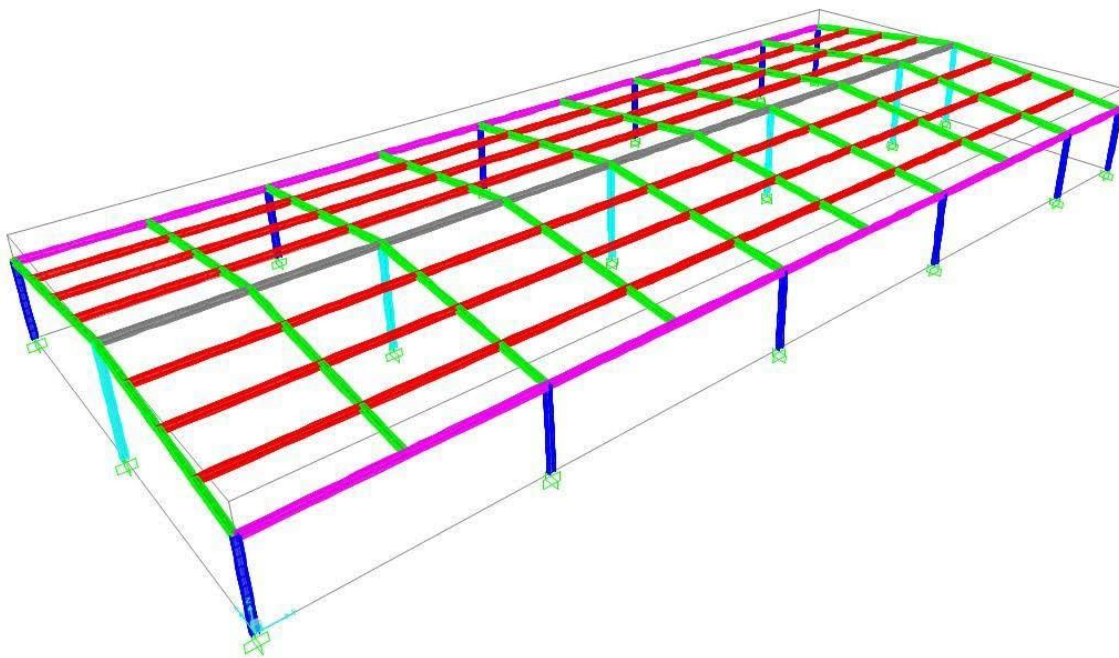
Imagem 3D da estrutura metálica do novo pavimento (SAP 2000). (Fonte: Autor)
